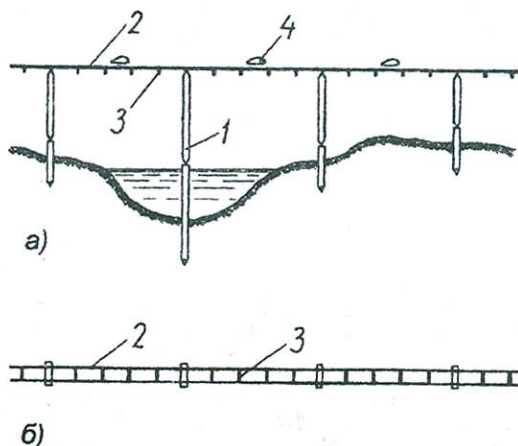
Схема размещения поперечных планок по длине трассы: а — вид сбоку на СТС; б — вид сверху; 1 — поддерживающая опора; 2 — рельс; 3 — поперечная планка; 4 — транспортный модуль
